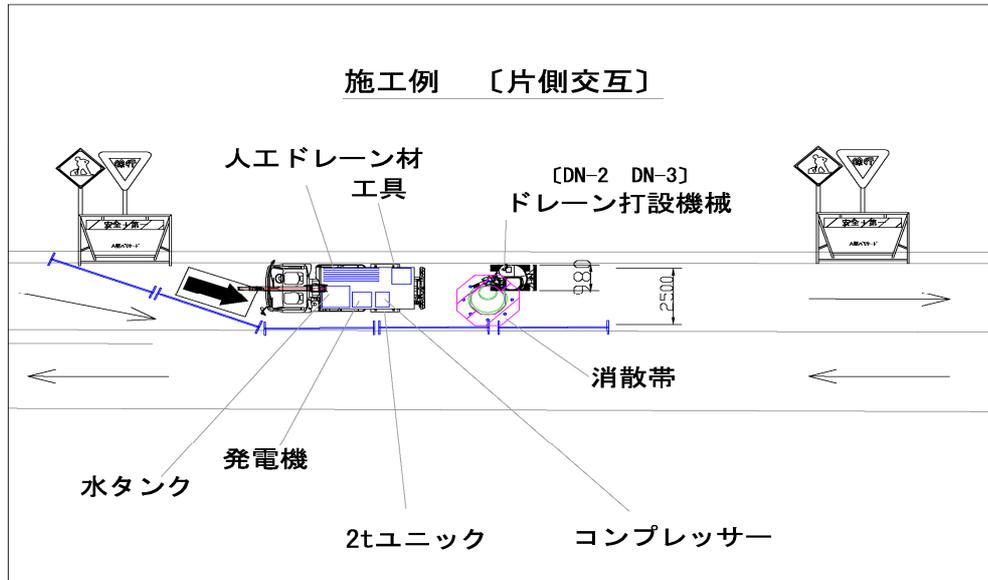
ドレーン打設 (DN-2・DN-3) 配置図
